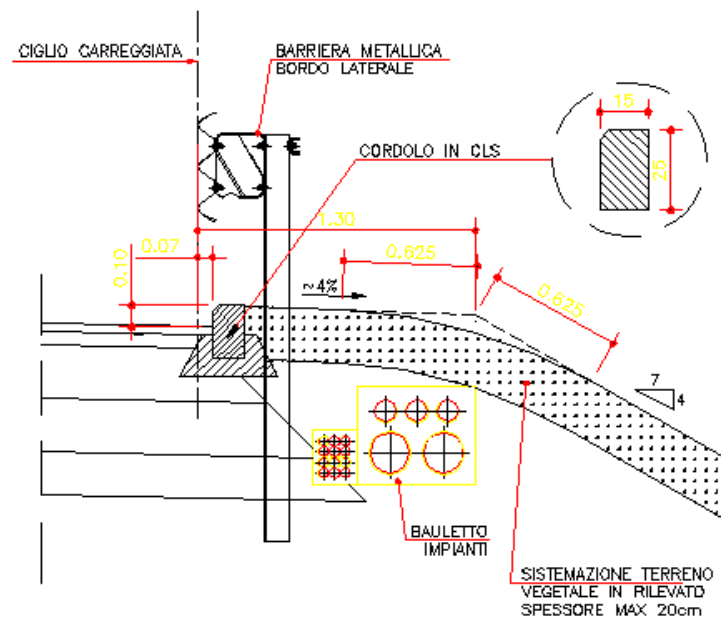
Sezione tipologica barriera metallica bordo laterale di progetto (fonte: Progetto definitivo – Elaborati di dettaglio)
